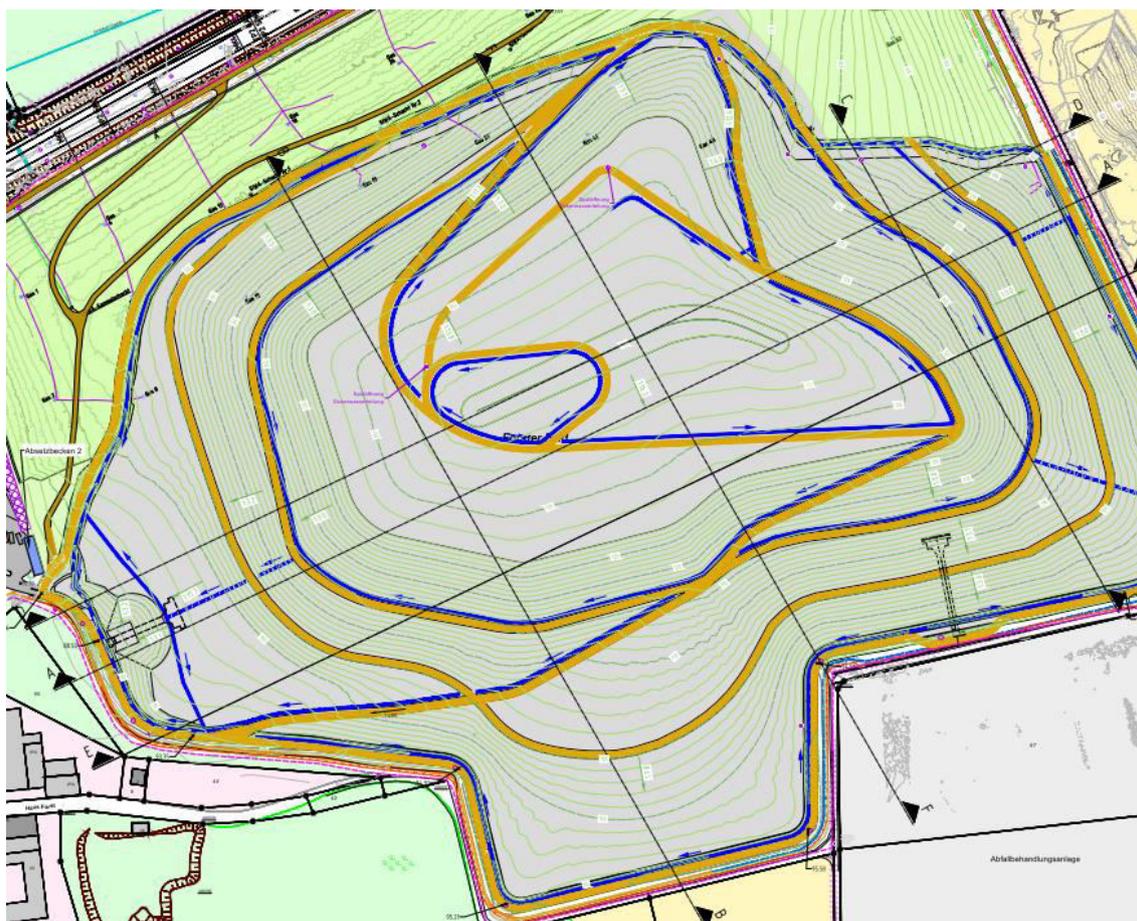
Lageplan endrekultivierte Deponie mit Lage der Prinzipschnitte.
